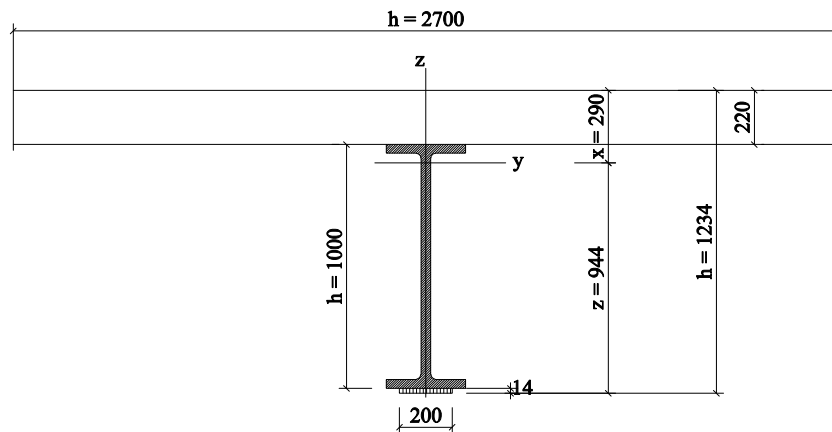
Расчетное объединенное сталежелезобетонное сечение
